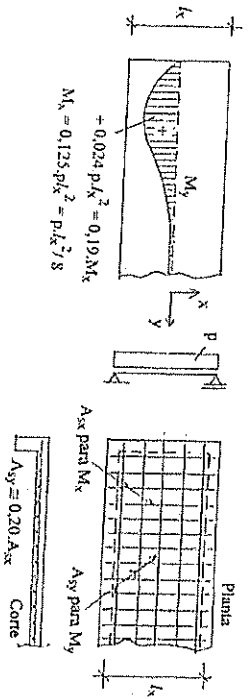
Momento transversal positivo em lajes armadas em uma direção
